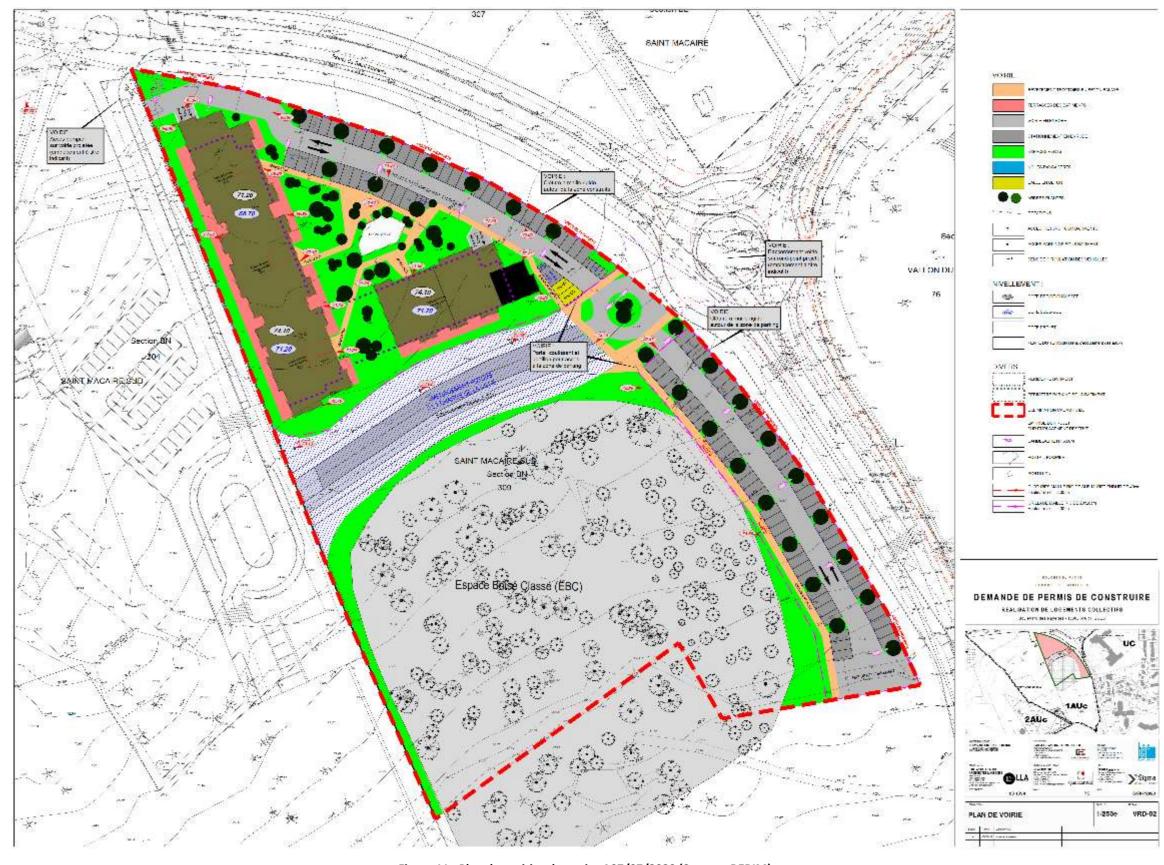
Plan des voiries du projet A07/07/2020 (Source: BERIM)
